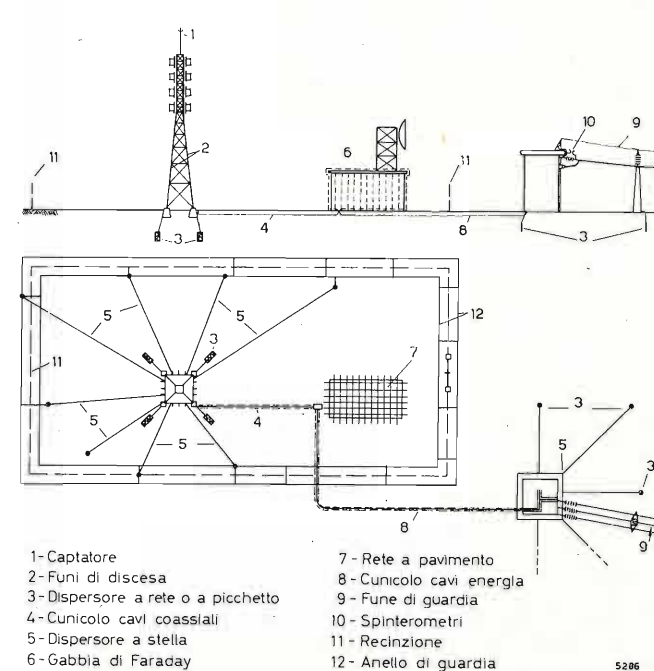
Impianto trasmittente con alimentazione dall'esterno. Schema dell'impianto di messa a terra.
